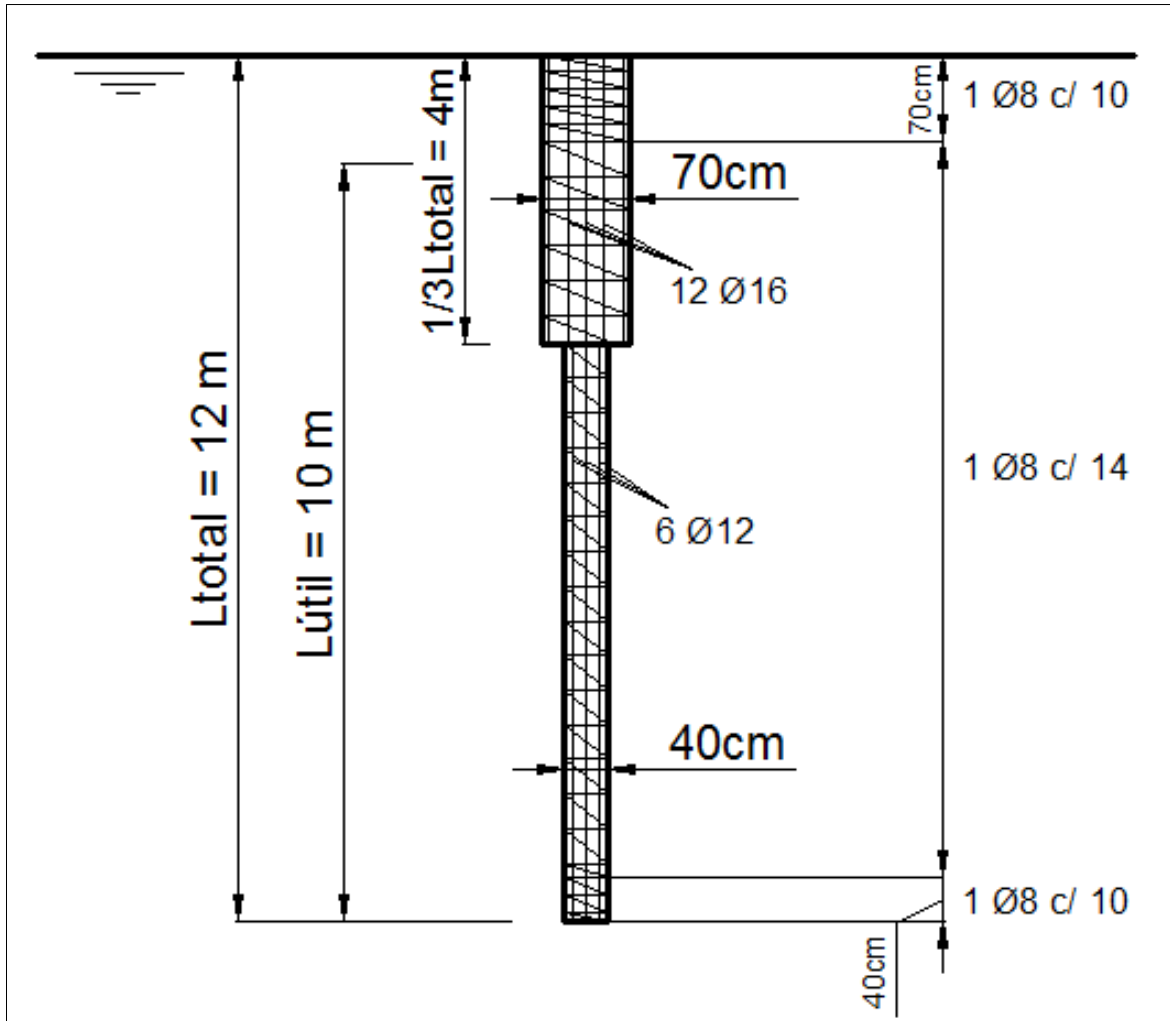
Esquema de la geometría final y armaduras adoptadas para el pilote tipo
